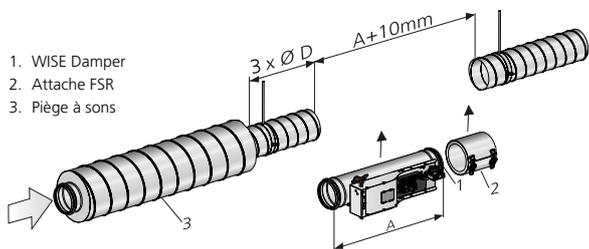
Requier une section droite de 3 x Ø pour les pièges à sons avec baffle ou corps central.
